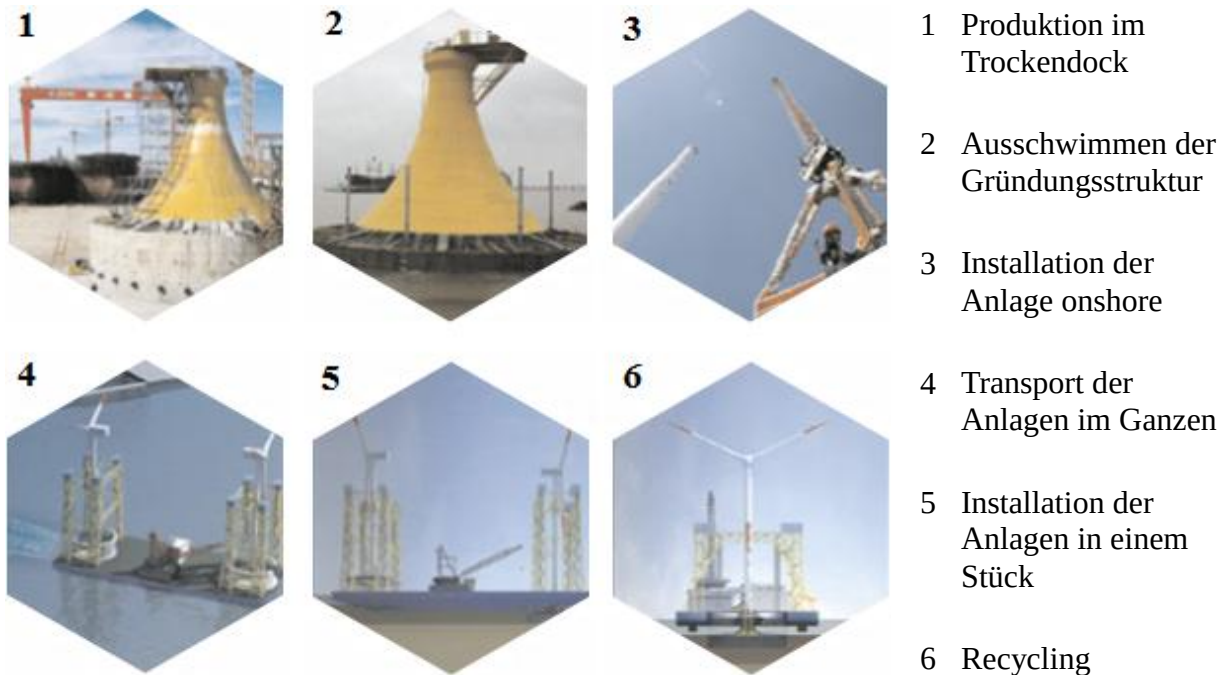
One-step-installation von OWEA mit großformatigen Suction-Bucket-Gründungen aus Beton (Ding, Lian, Li, & Zhang, 2013)
